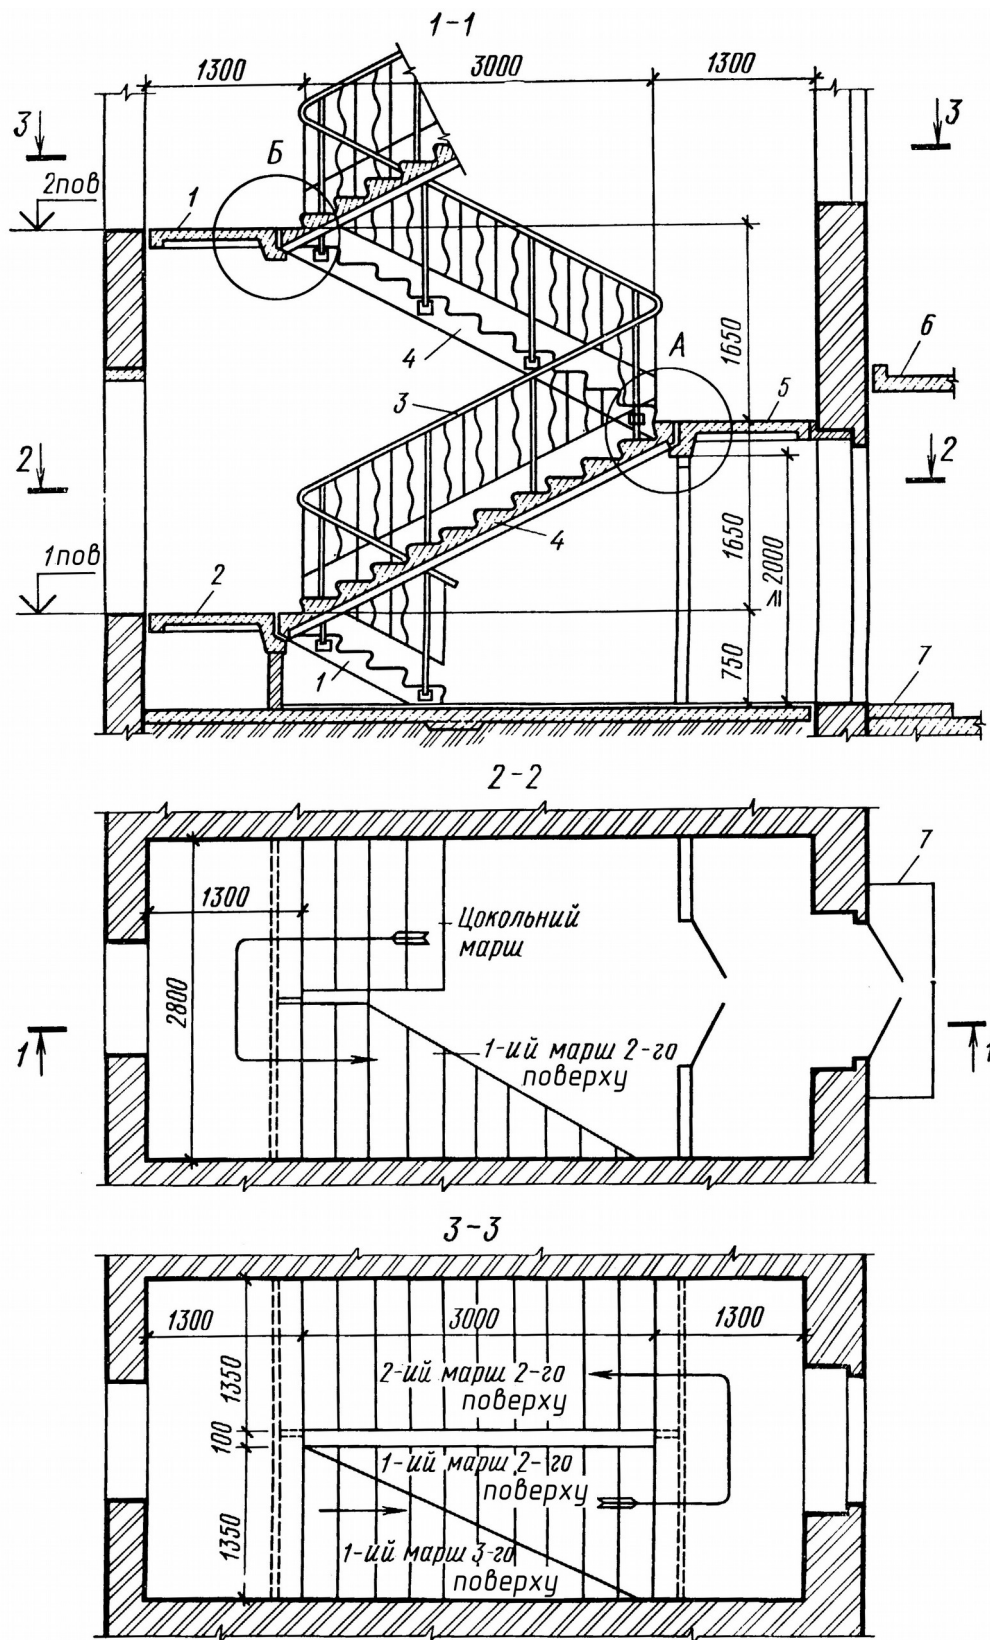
Двомаршові сходи (розріз і поверхові плани):
